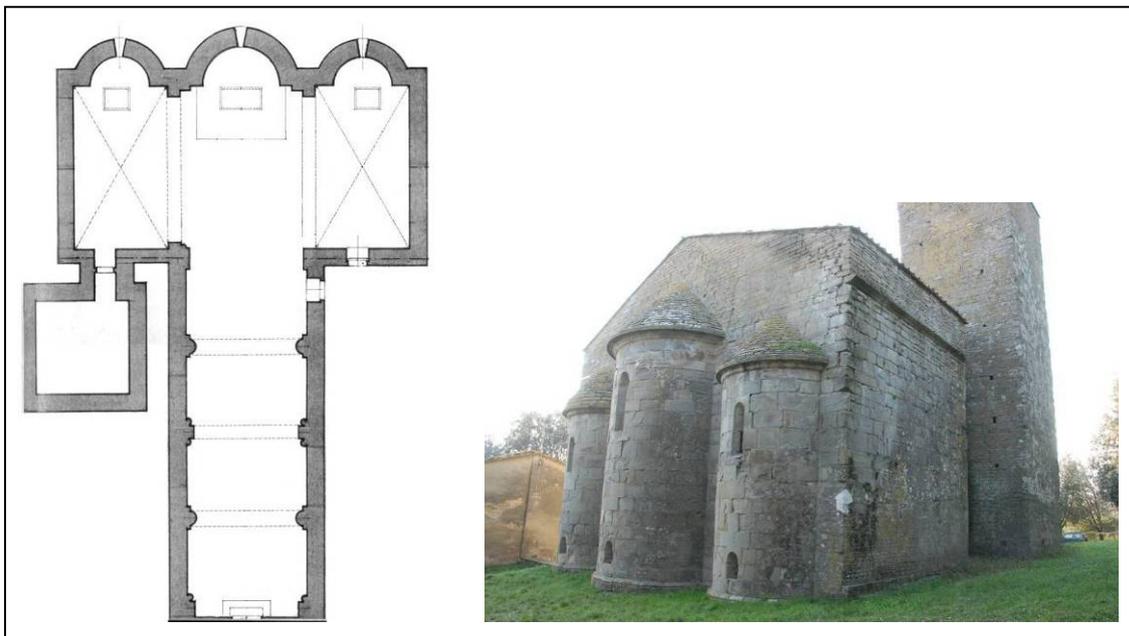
San Giusto al Pinone: pianta e vista della zona absidale
